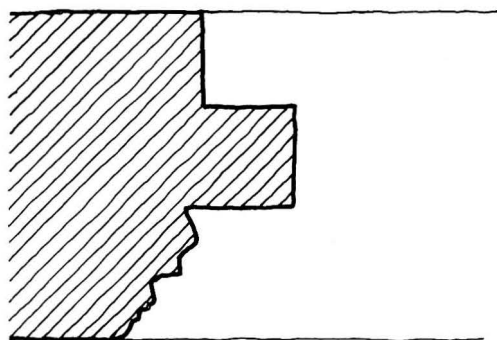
Rester av det södra fönstret i gaveln på oktagonens västra mur, plan, 1:20. Uppm E Bohrn 1979.
